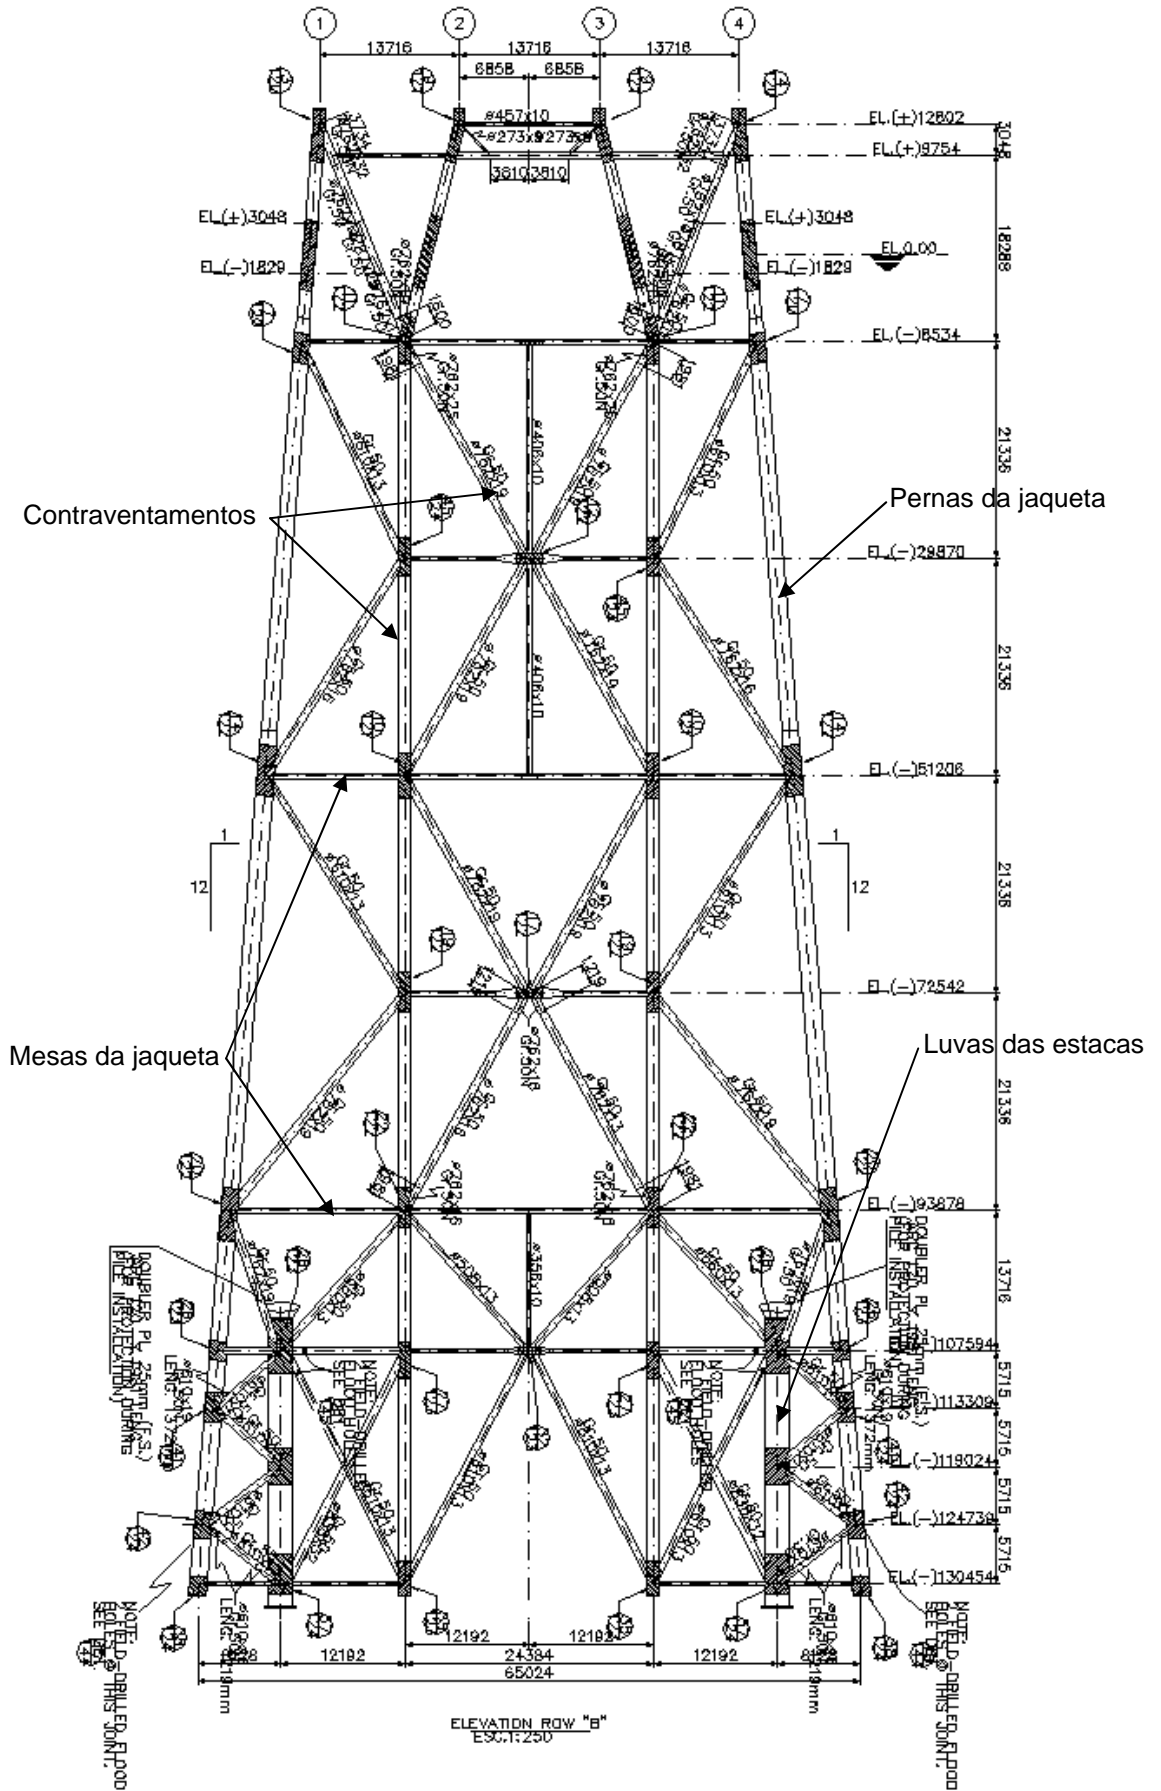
Jaqueta – Elevação do Eixo B (cotas em mm)
